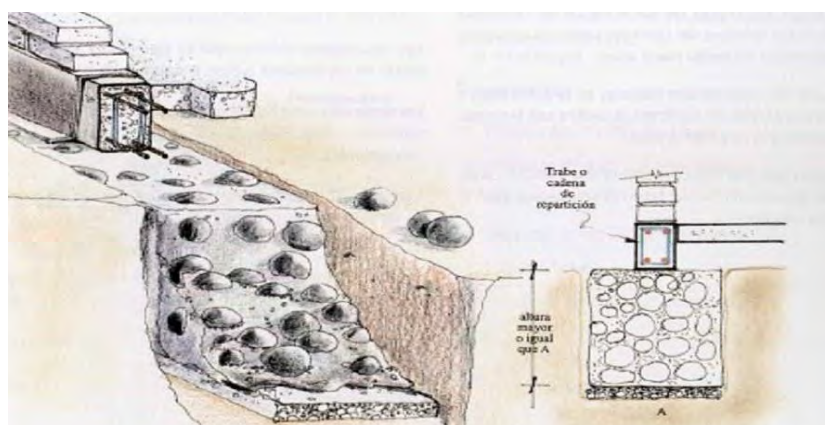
Hormigón ciclópeo (www.elconstructorcivil.com).
